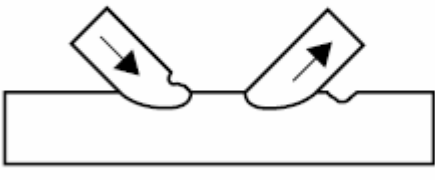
Başlık elemanında kesme zımbalaması göçme biçimi (Corus Tubes, Design of SHS Welded Joints)
